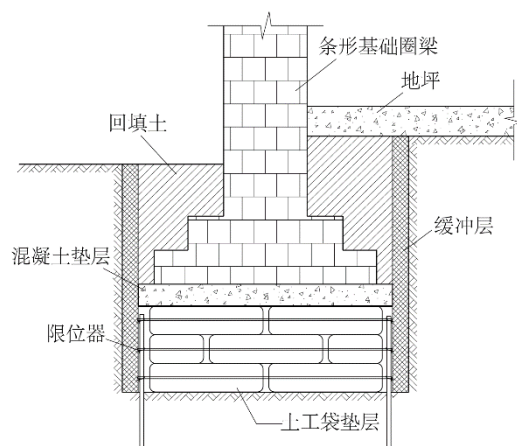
条形基础下土工袋垫层布置示意图
